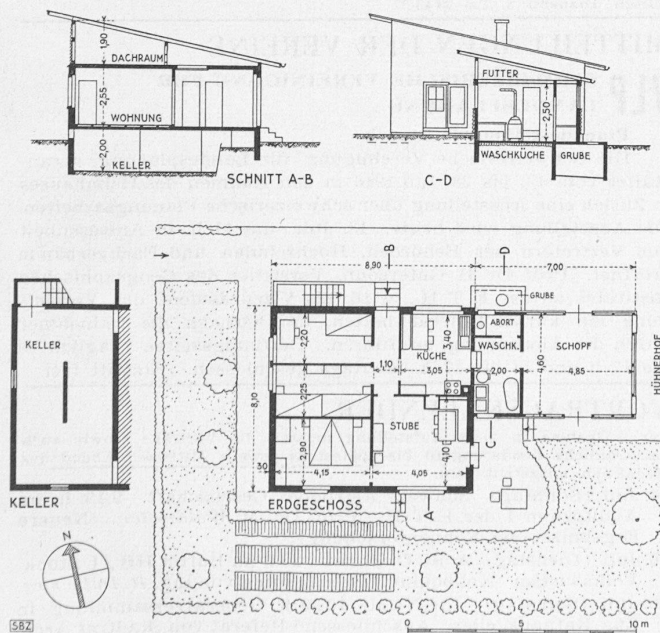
Haustyp, Grundriss und Schnitte, Masstab 1 : 300
